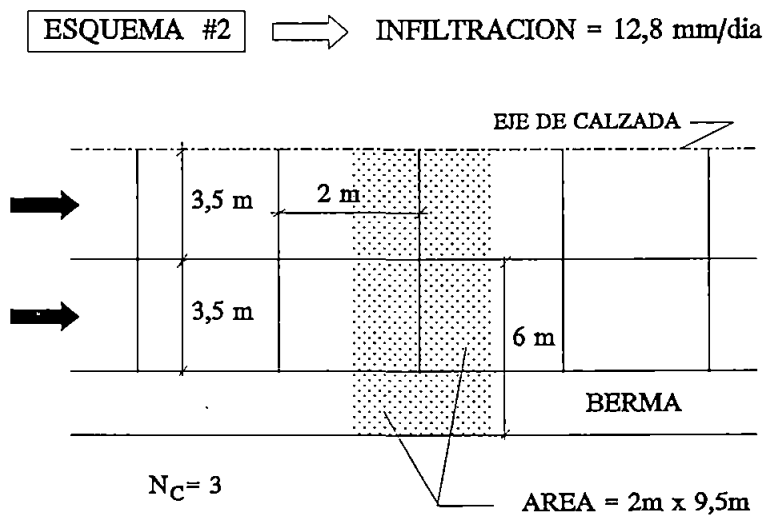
Esquema del modelo de Infiltración aplicado a calzada unidireccional.
